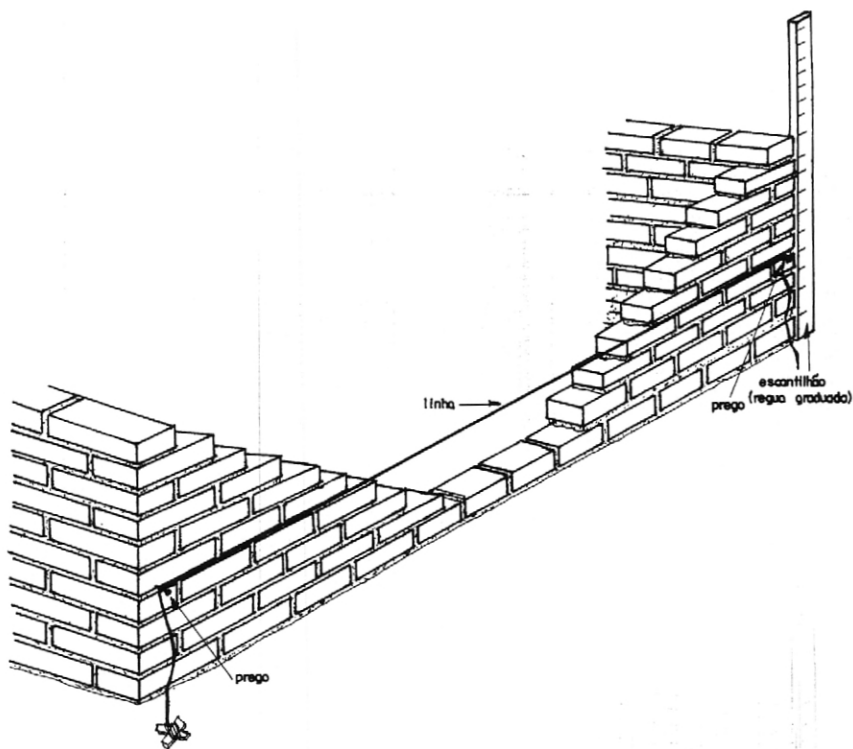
Detalhe do nivelamento da elevação da alvenaria.
